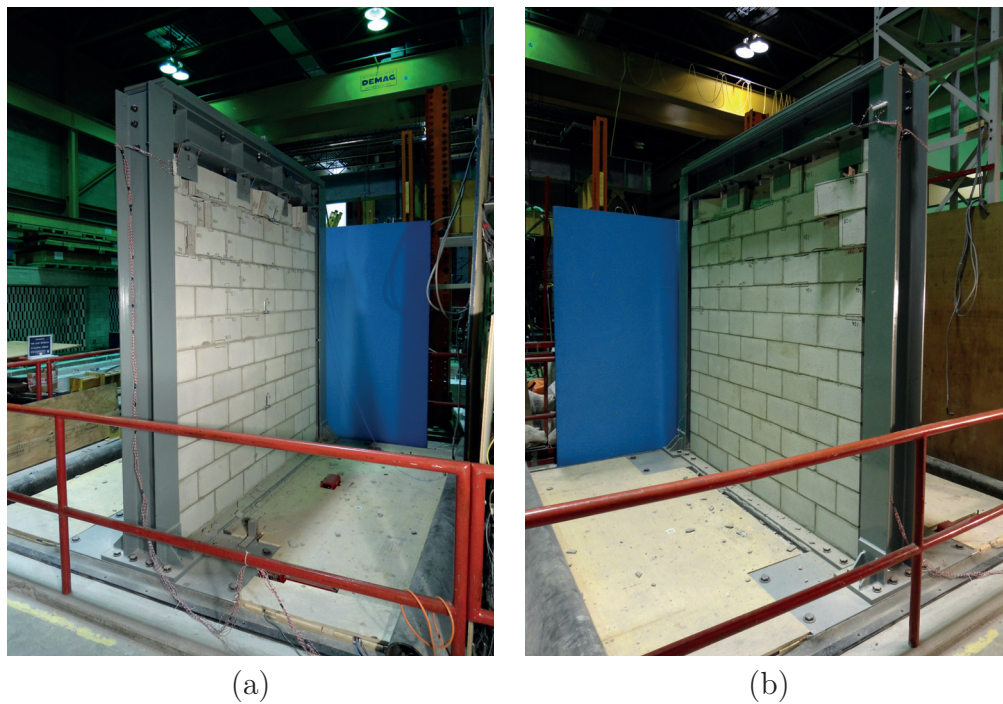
Photos de l'endommagement du mur 1 après le dernier essai (MAL19-0.90) (a) façade avant (b) façade arrière
